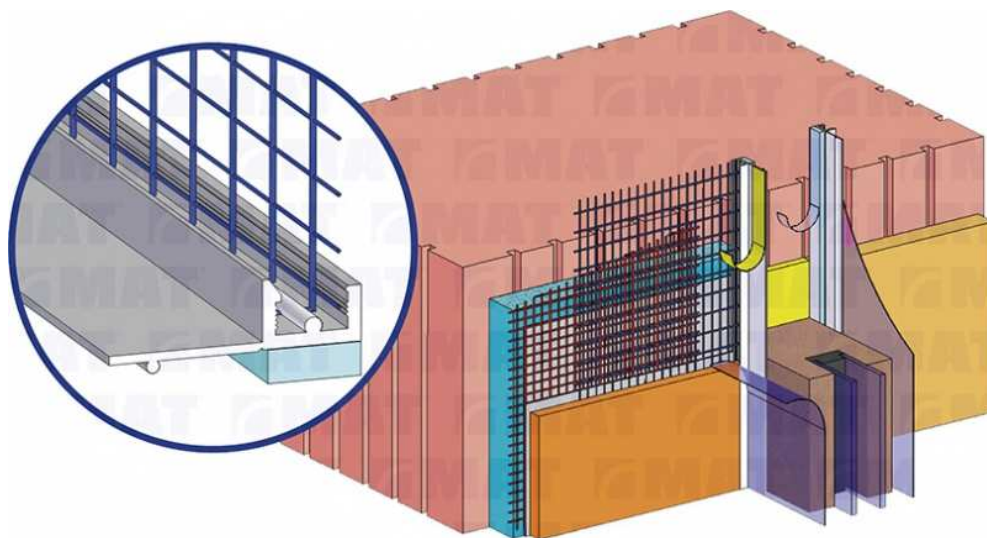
Detail - začišťovací lišta u okenního rámu
